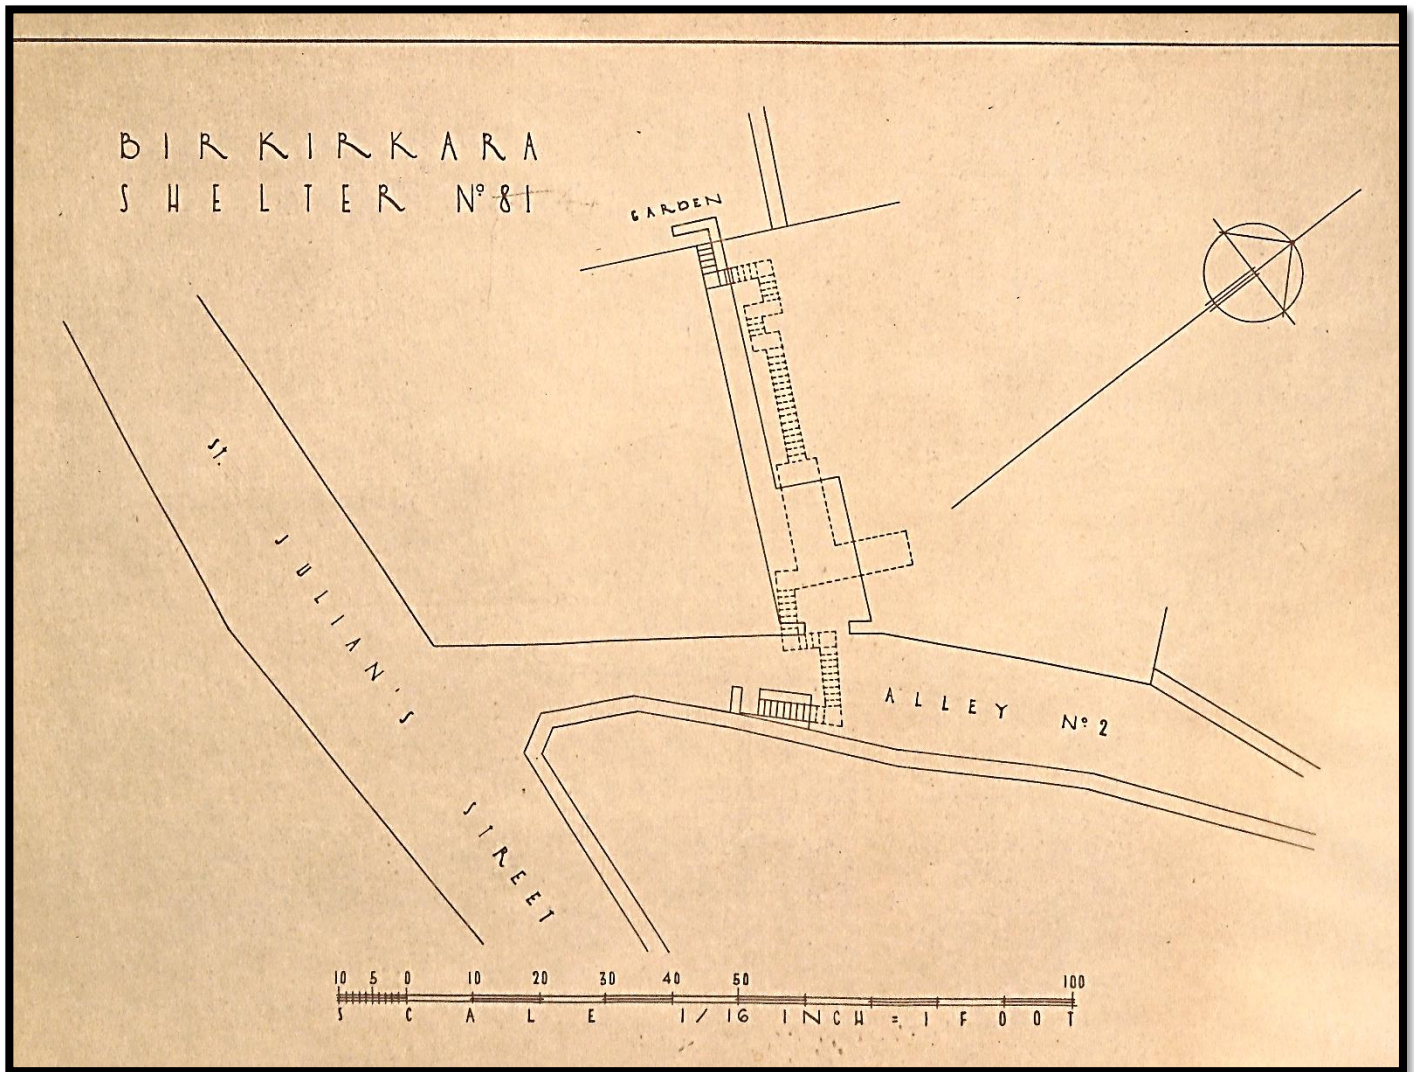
Planta do Abrigo nº 81 (14) "St. Julian's Street – Alley nº2."
